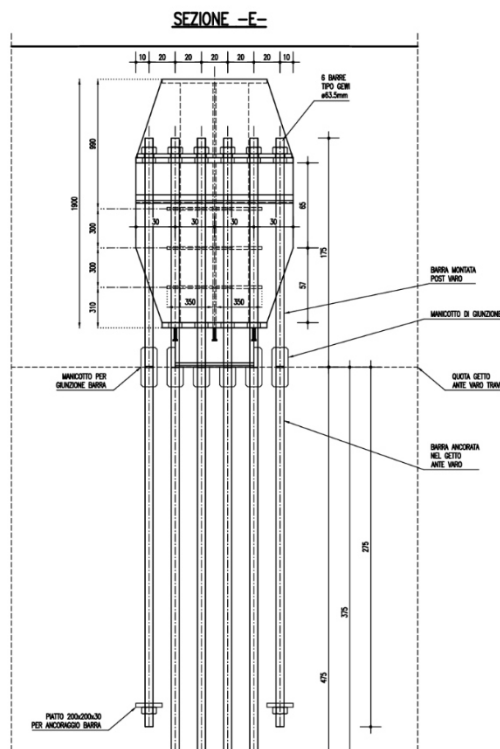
Dettaglio carpenteria metallica nodo spalla-impalcato, vista da dietro
